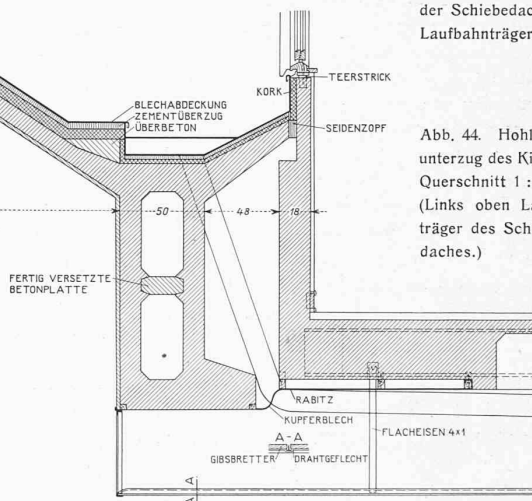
Hohler Hauptunterzug des Kinodaches, Querschnitt 1 : 40. (Links oben Laufbahnträger des Schiebendaches.)
